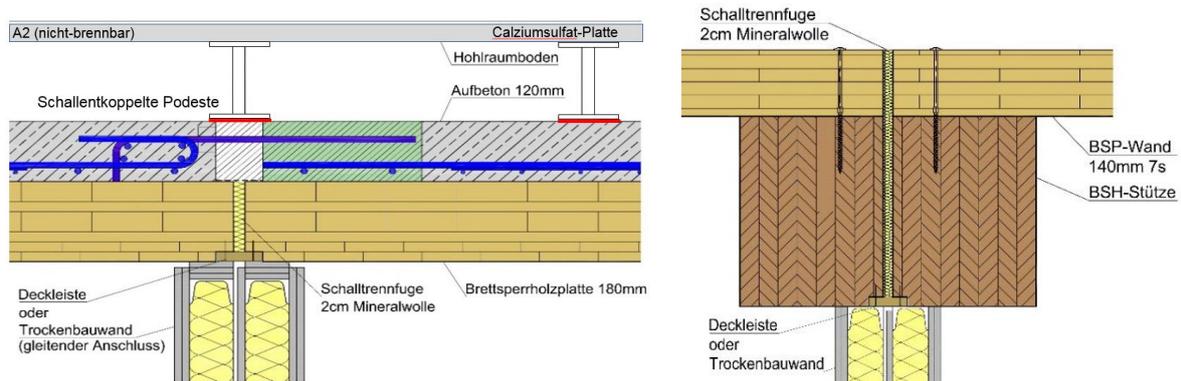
Konstruktionsdetails im Schallschutz: Schalltrennfugen in Decke und Wand/Stütze
